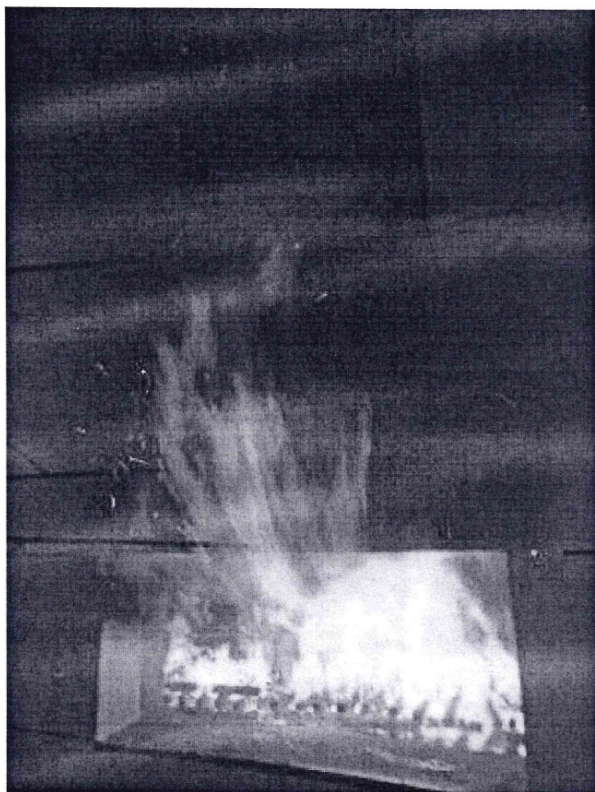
Фрагмент образца фасада при испытании по ГОСТ 31251-2008.
